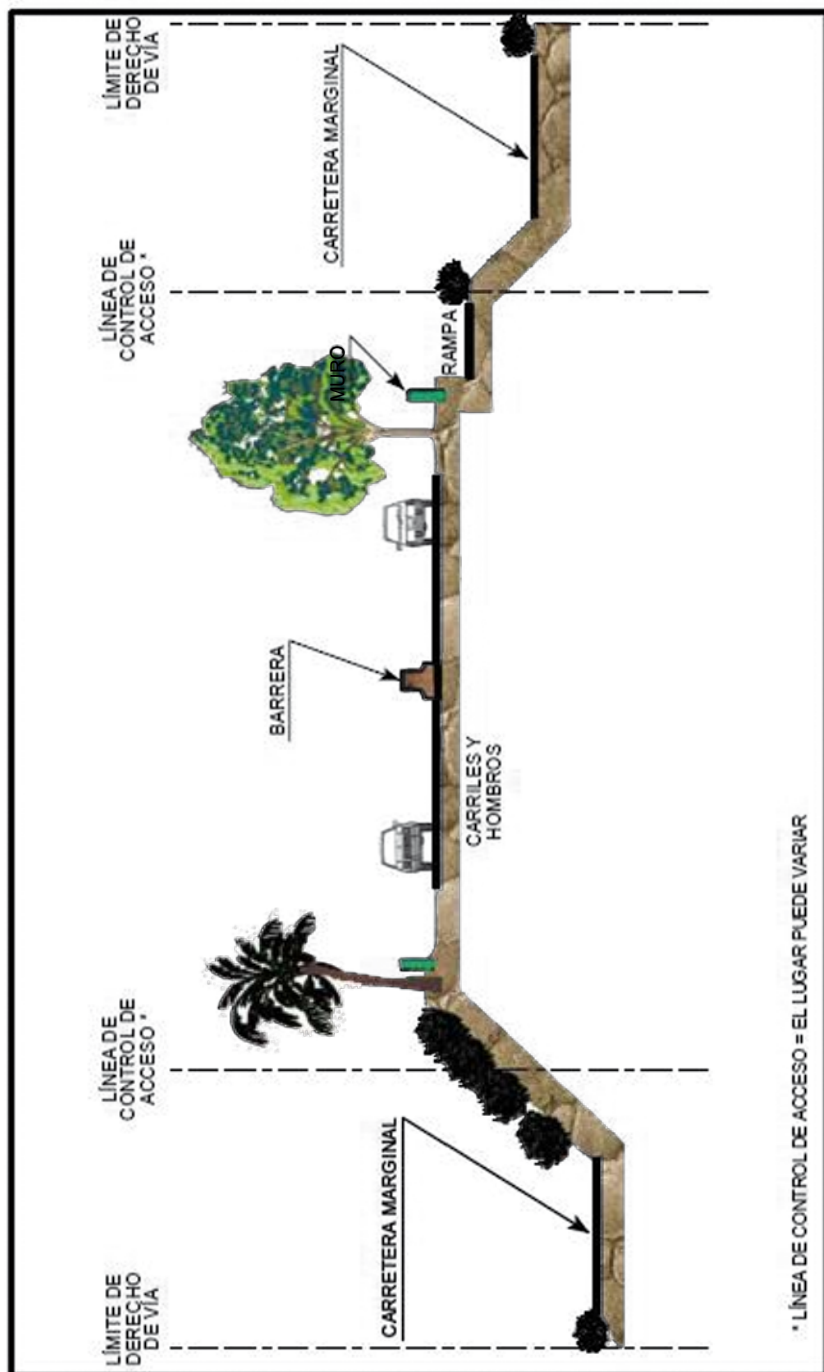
AUTOPISTAS ELEVADAS EN TERRAPLENES
